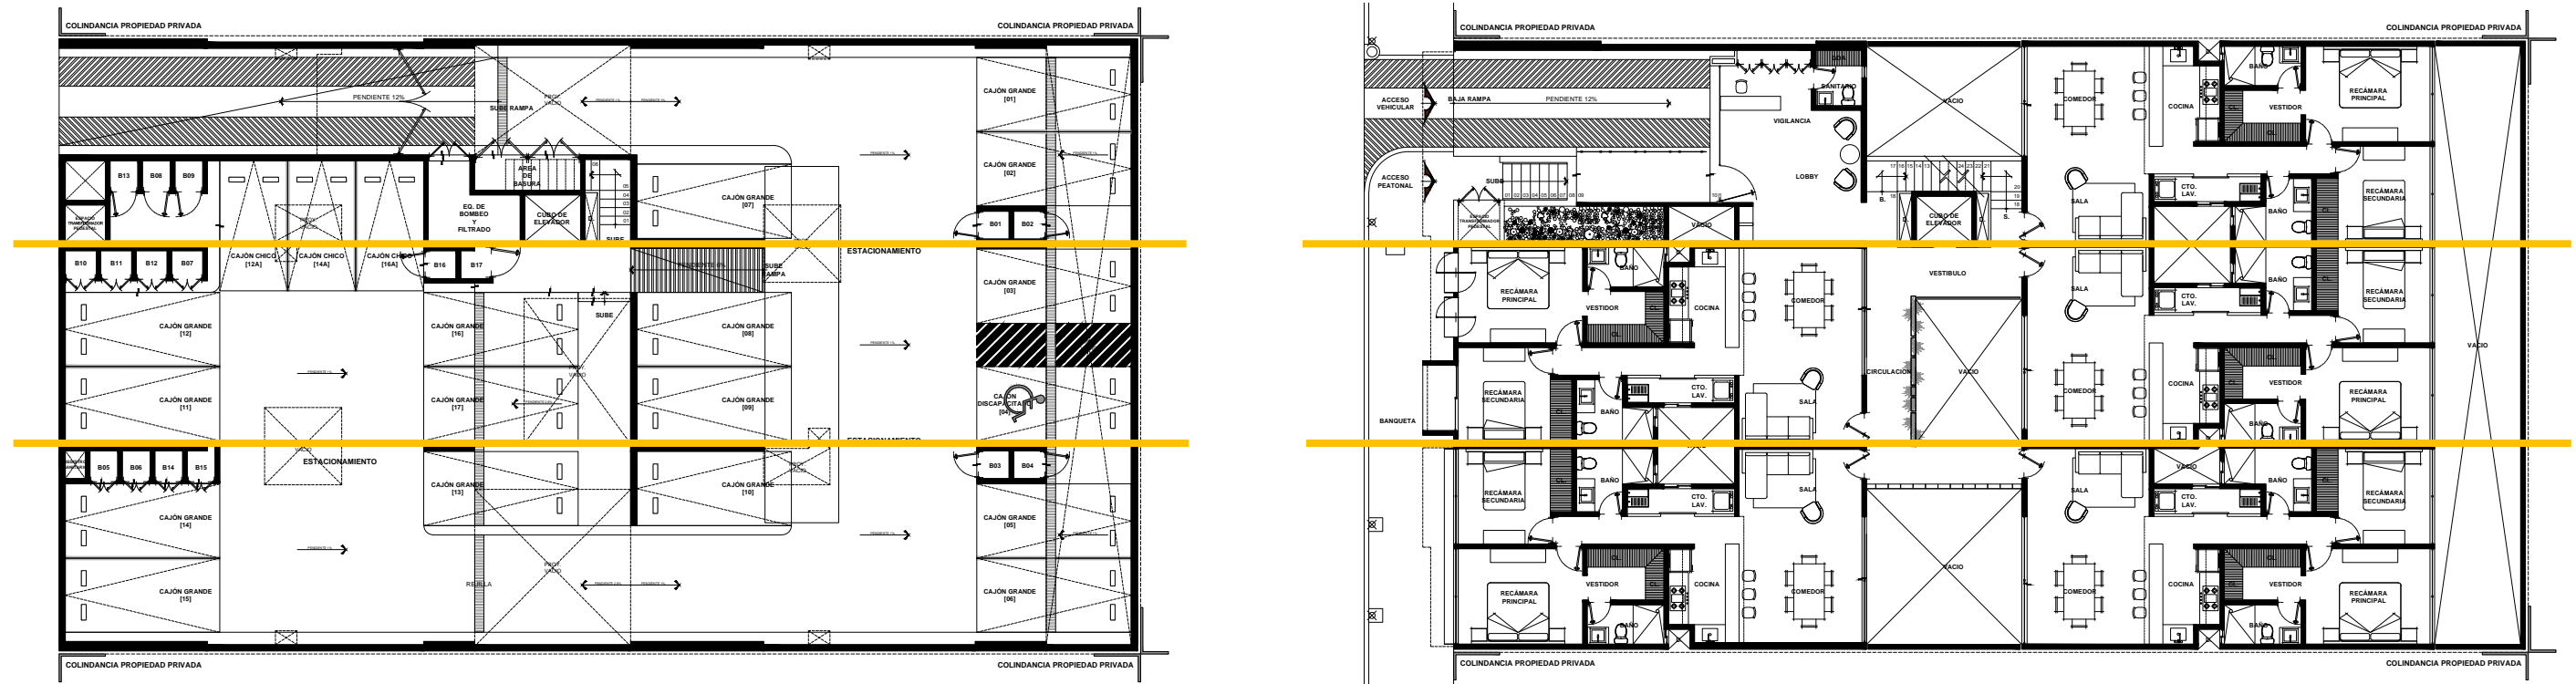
Plantas arquitectónicas de semisótano y planta de acceso. Elaboración equipo de proyectos y diseño de interiores. Año 2019
